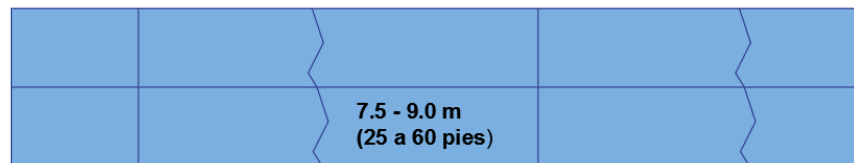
Juntas en pavimentos de Concreto Simple. Fuente: Tópicos de Pavimentos de concreto
